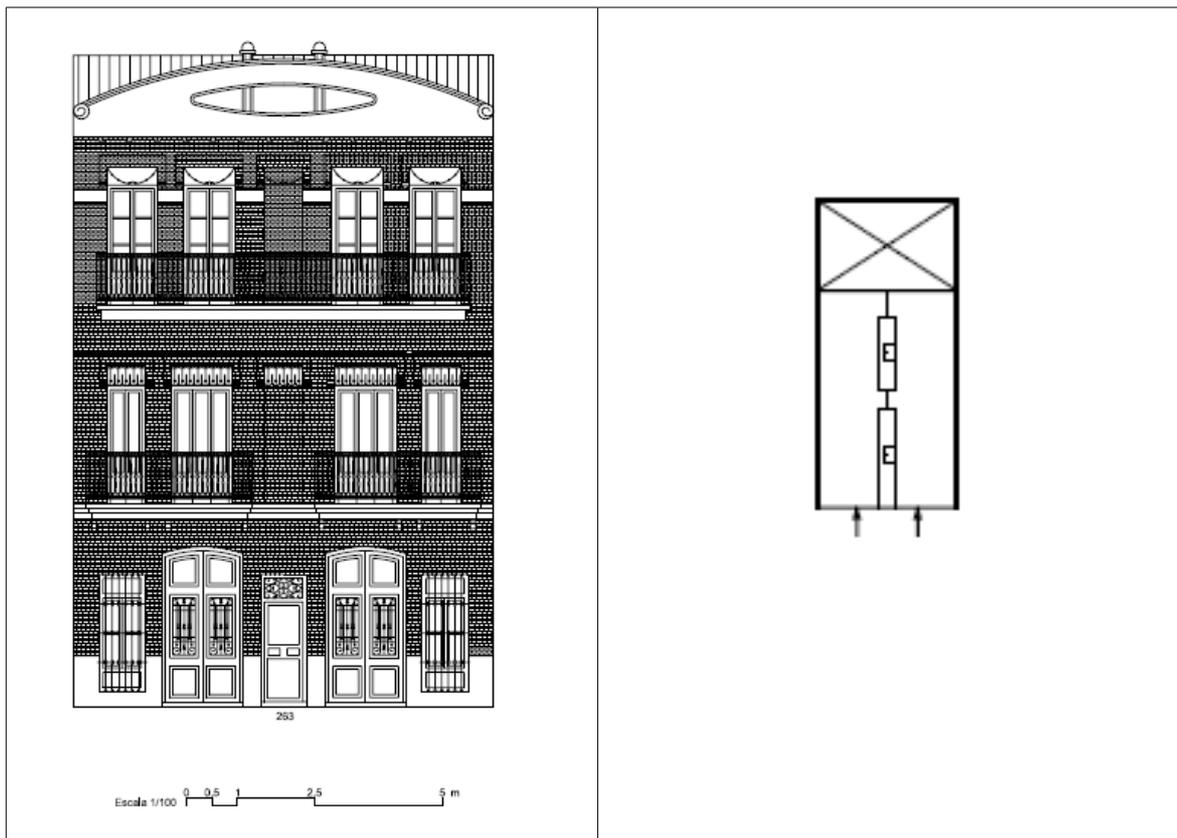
Tipo C2. Ejemplo de fachada y esquema de planta (ficha 125-09)
